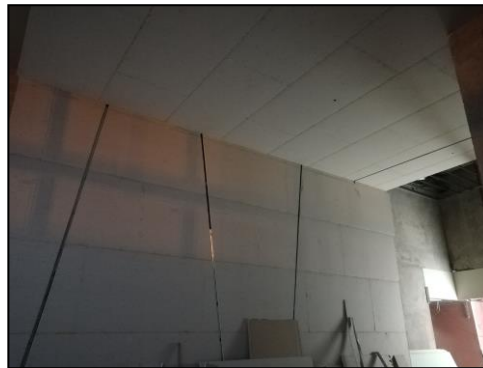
Instalación de plancha estándar en muro doble altura, sótano 1.
